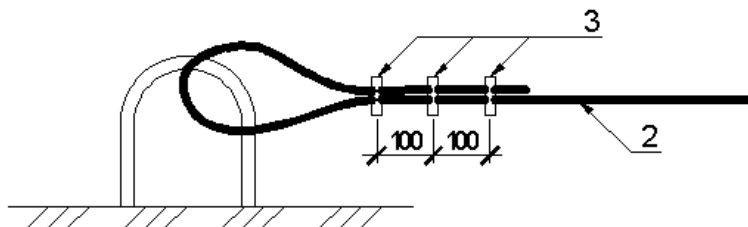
Армирование второго (вышележащего) яруса подпорной стены: 1 – плита ПТП 6х1,5м; 2 – стальной трос 10,5мм для крепления к нему монтажного пояса; 3 – зажимы ЗК-13 – 3шт с каждой стороны; 4 – подпорная стена.
